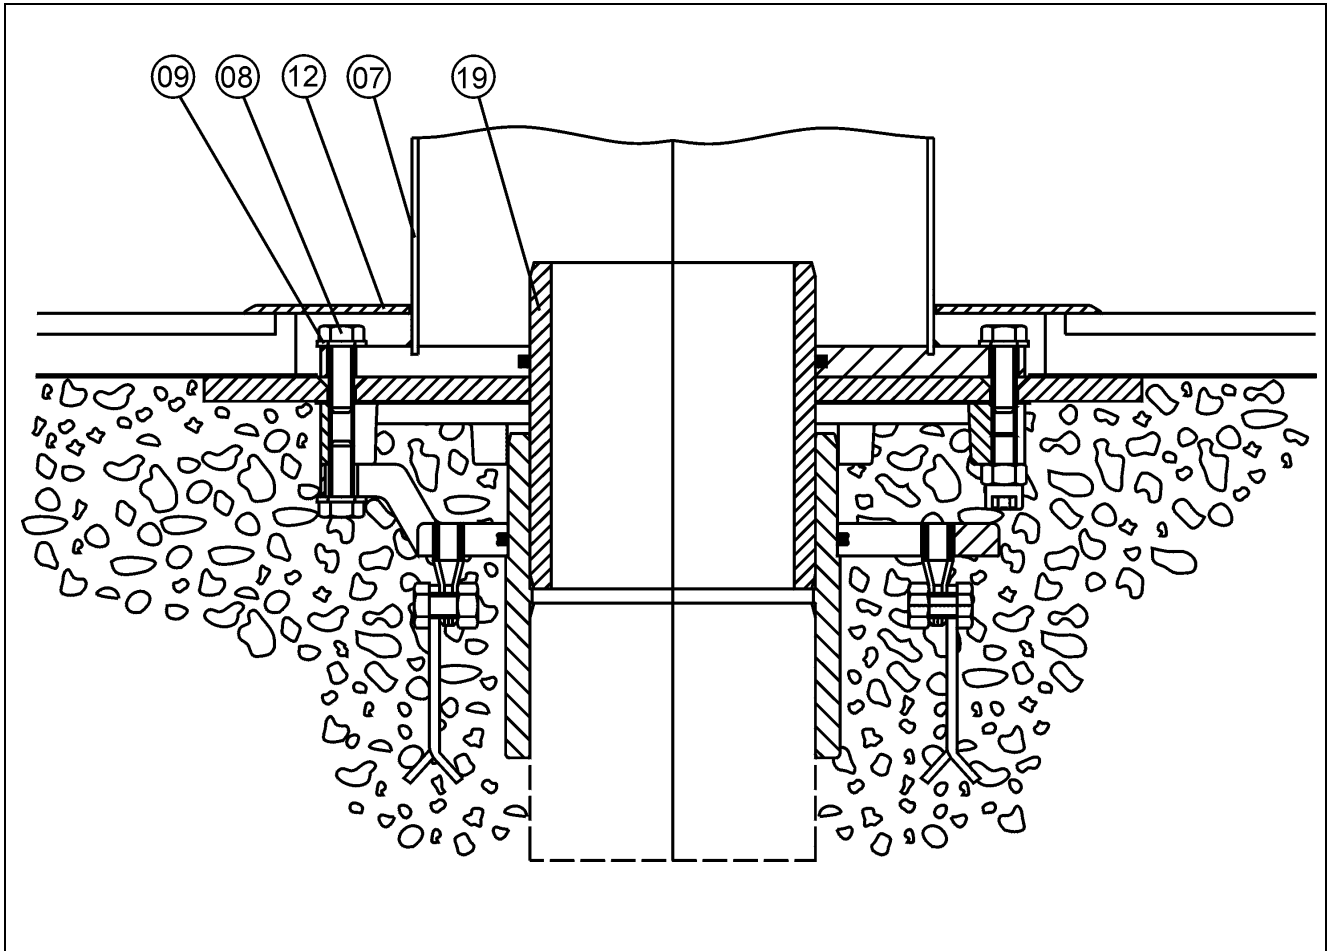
Betonbecken gefliest / Wasserzuführung 90°
